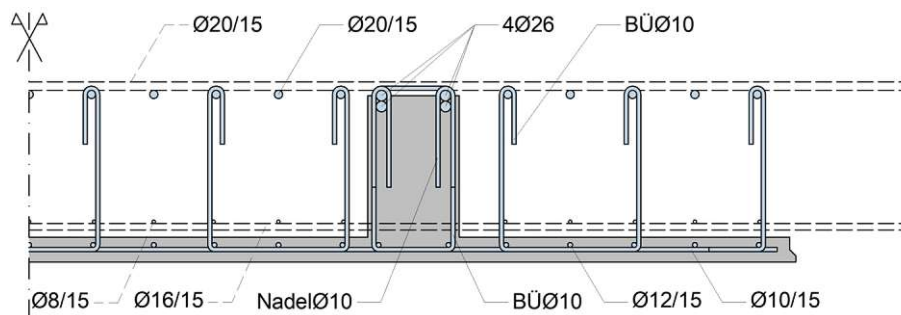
Bewehrung Halbfertigteil Typ Z.
